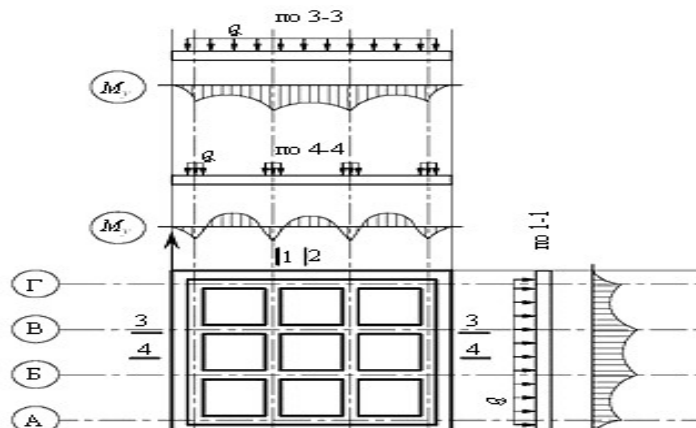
Епюри згинальних моментів у перерізах плитного фундаменту при дії розподіленого по периметру стін навантаження.
